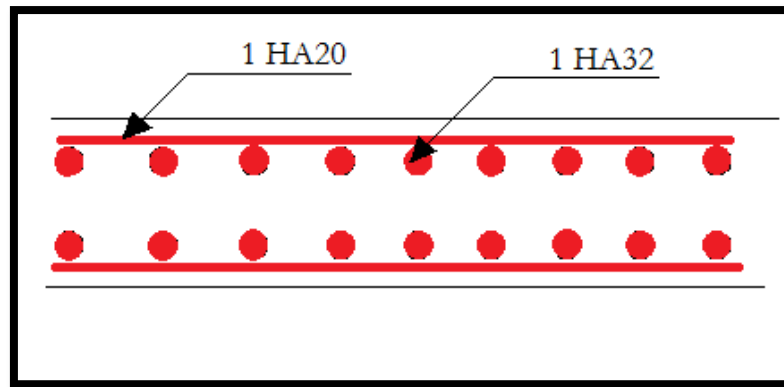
Ferrailage du mur en retour (vue en plan).
